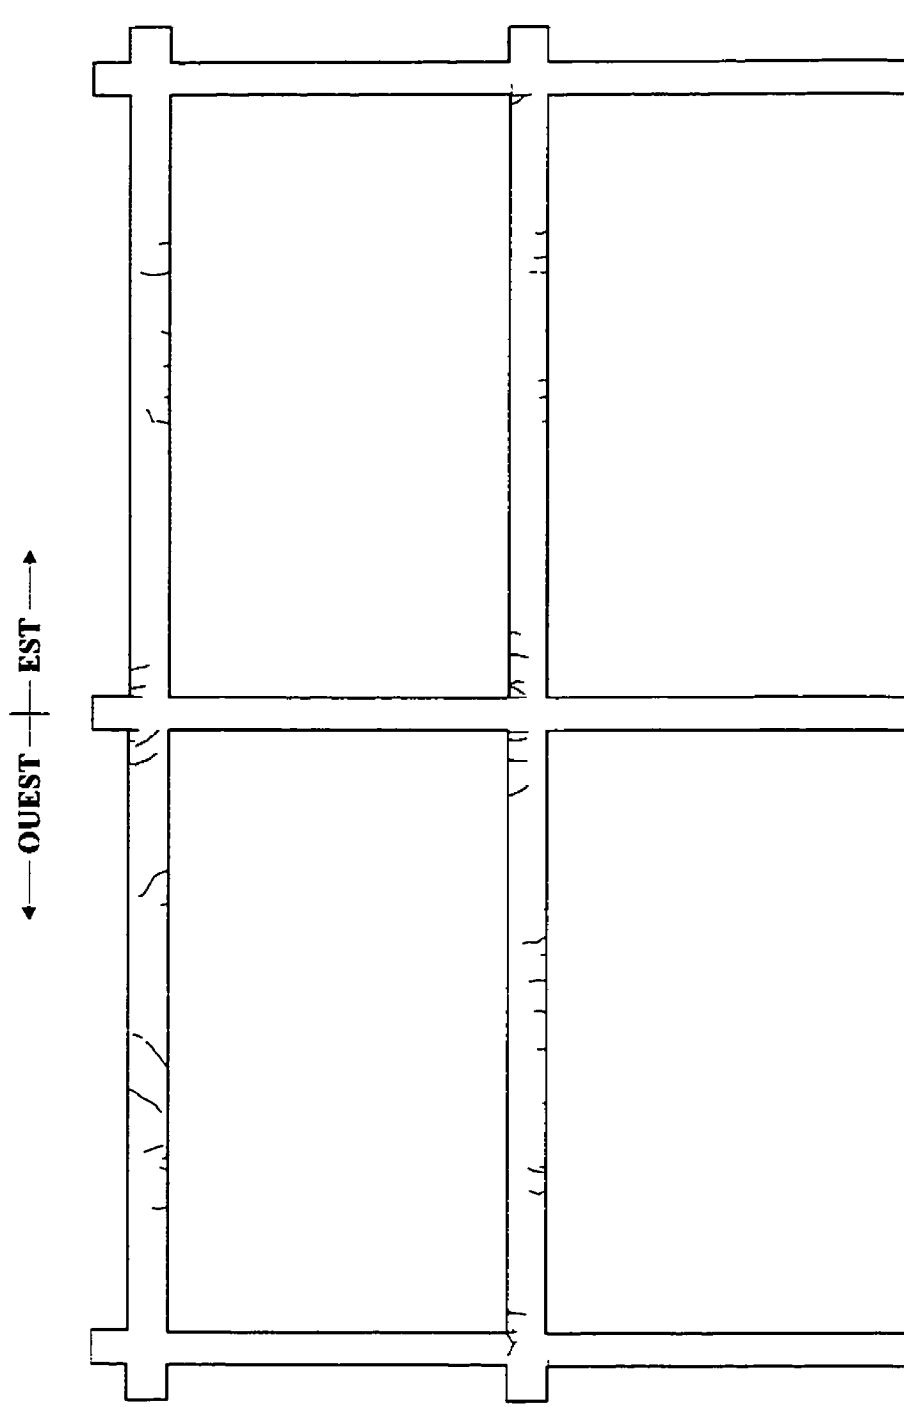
Champ de fissuration (chargement statique).
